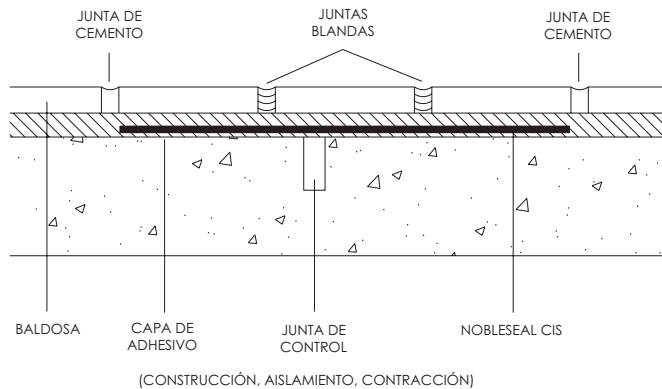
PUENTE DE JUNTAS – CORTE TRANSVERSAL
